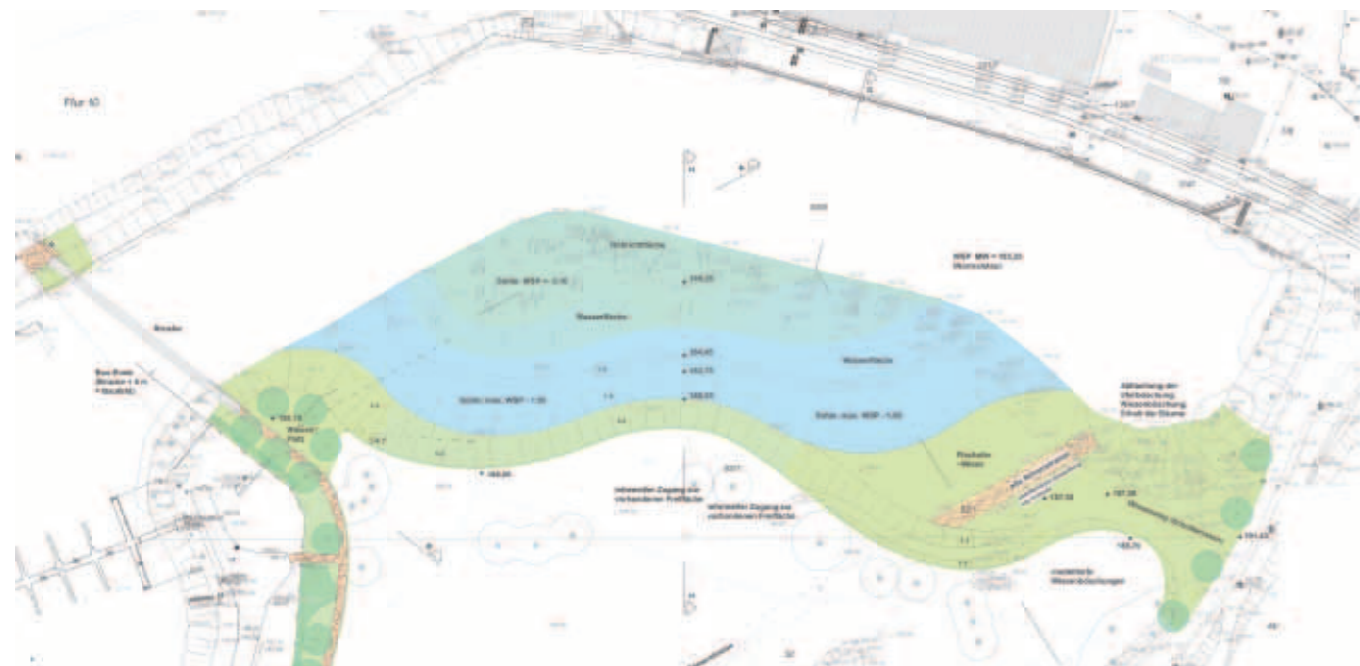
Lageplan Entwurfsplanung, GLF Plan
